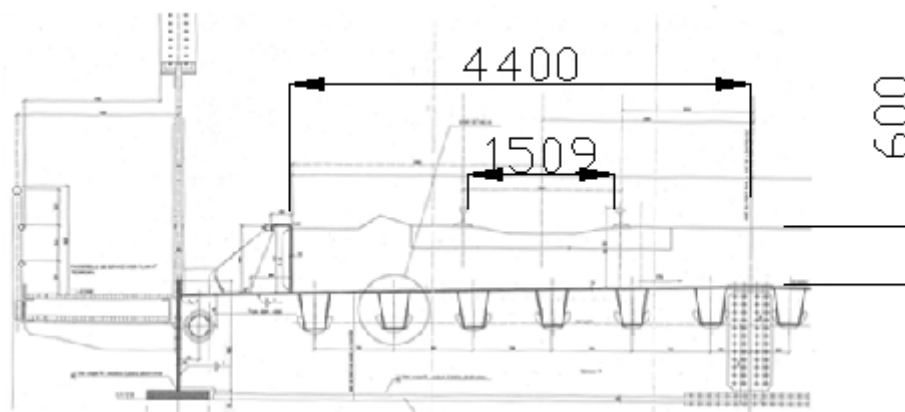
Secção transversal do tabuleiro e passadiço (mm)
